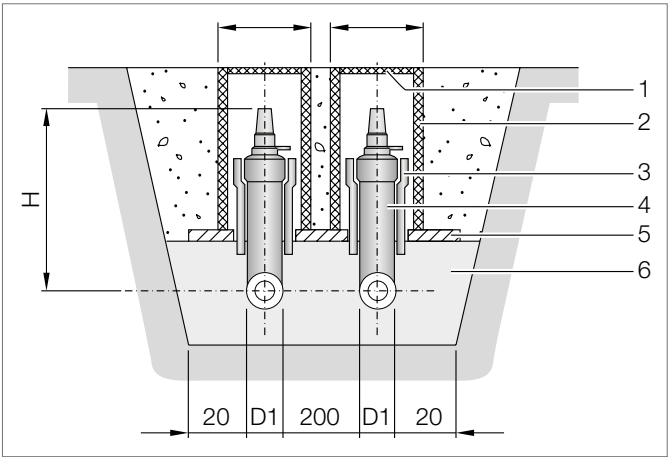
Schéma de montage vanne pré-isolé (dimensions en cm).
